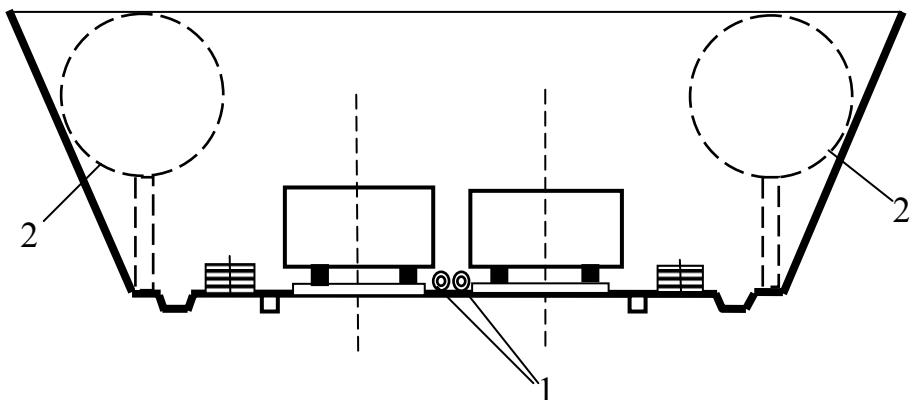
Варианты размещения трубопроводов карьерных водоотливных и вентиляционных установок в крутой траншее карьерного подъемника
